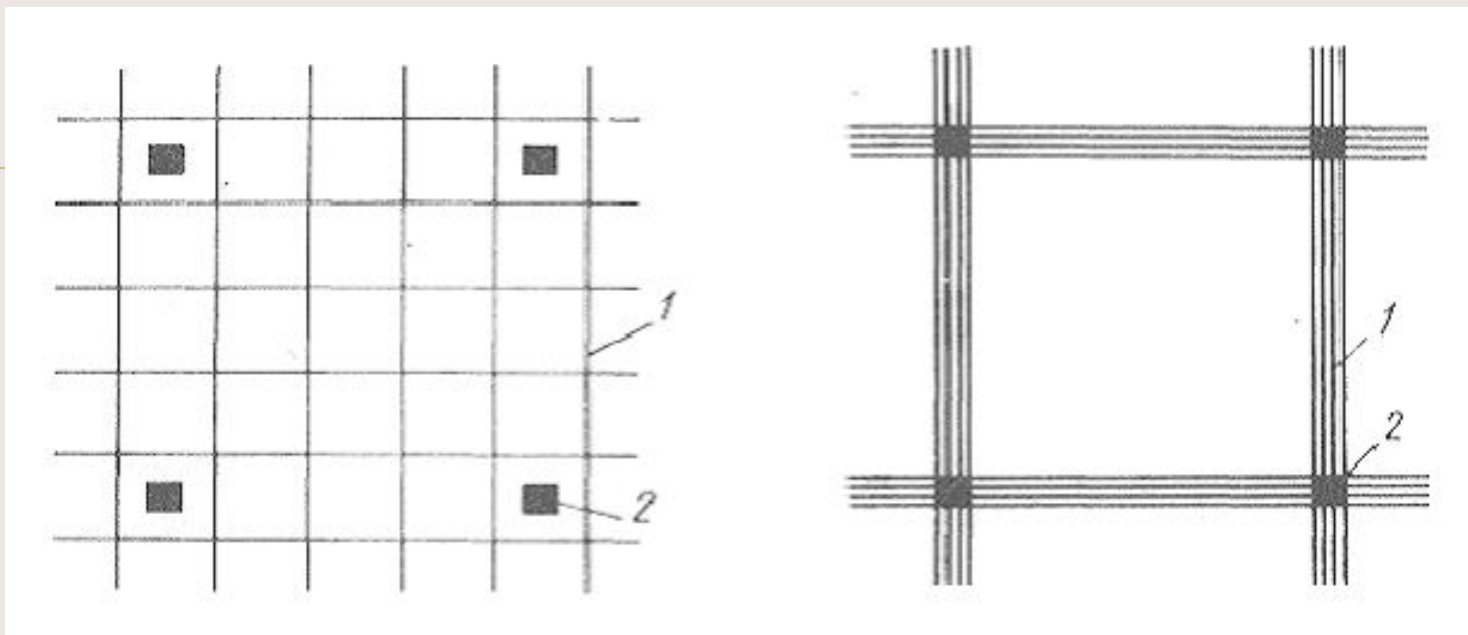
Размещение напрягаемой арматуры в монолитной плите перекрытия
